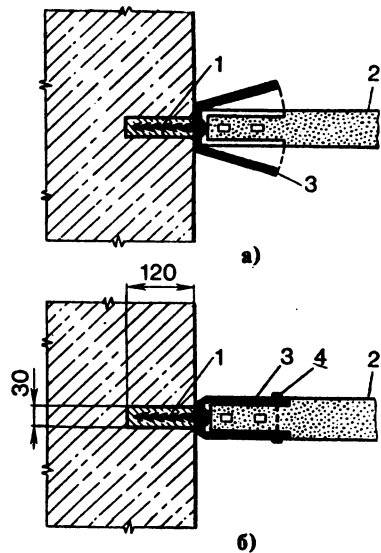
Положения крепления панельных перегородок к стенам вилочной скобой: а — при установке, б — после установки; 1 — ерш, 2 — перегородка, 3 — скоба, 4 — гвозди
